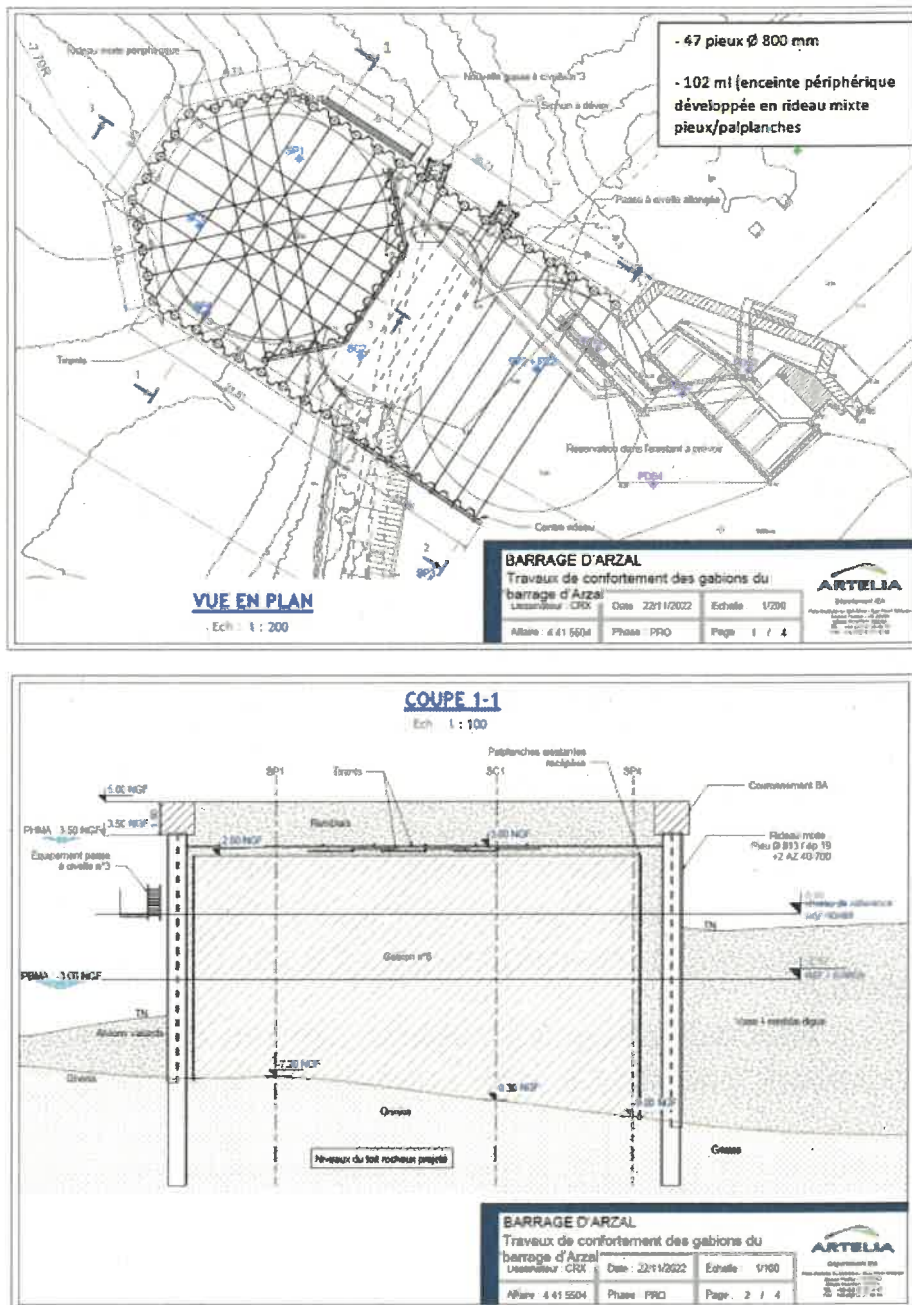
Vue en plan et coupe transversale de la solution retenue, rideau mixte de type combiwall
